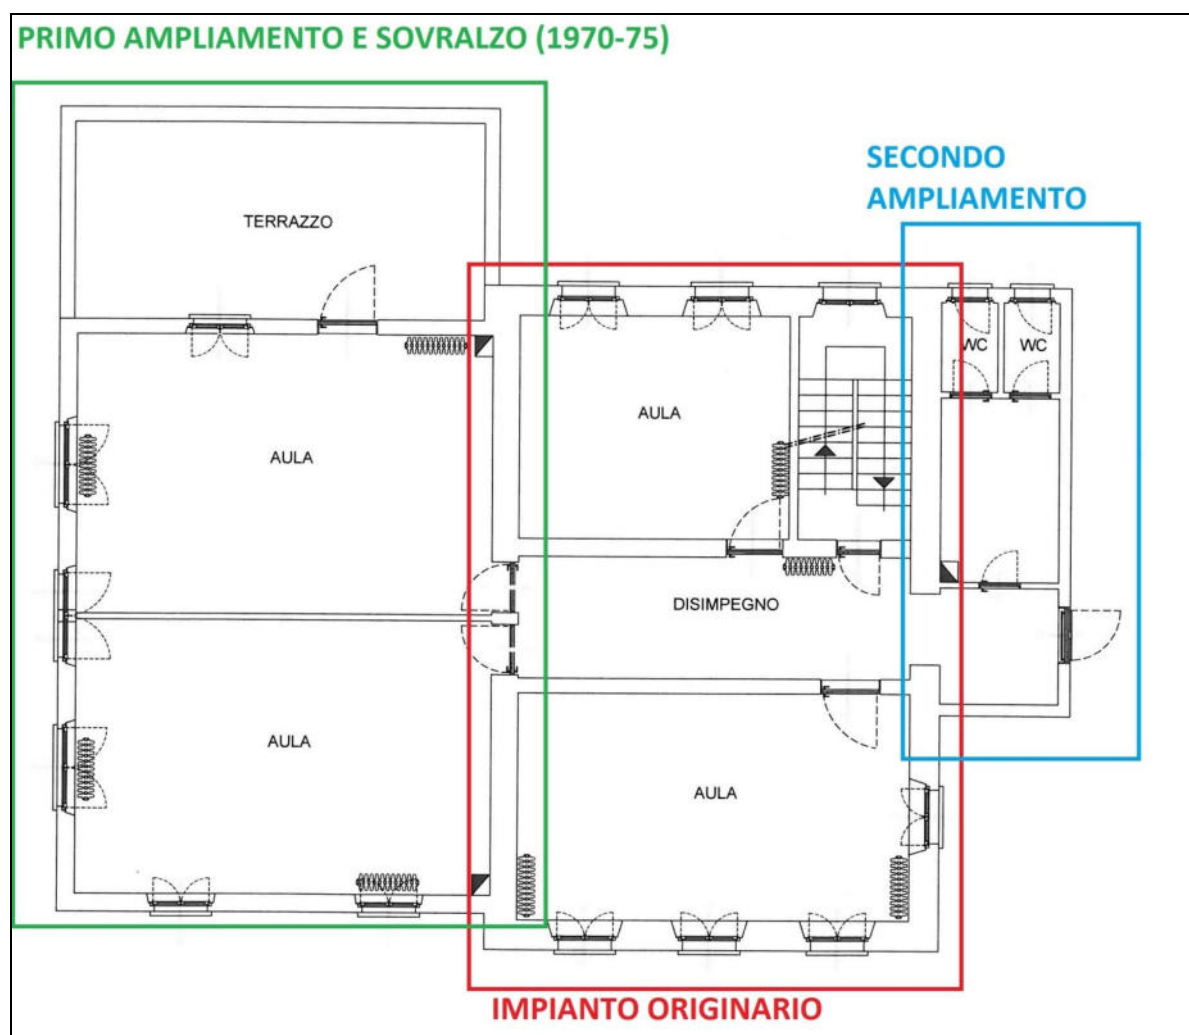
Sintesi delle modifiche strutturali – Piano primo.
